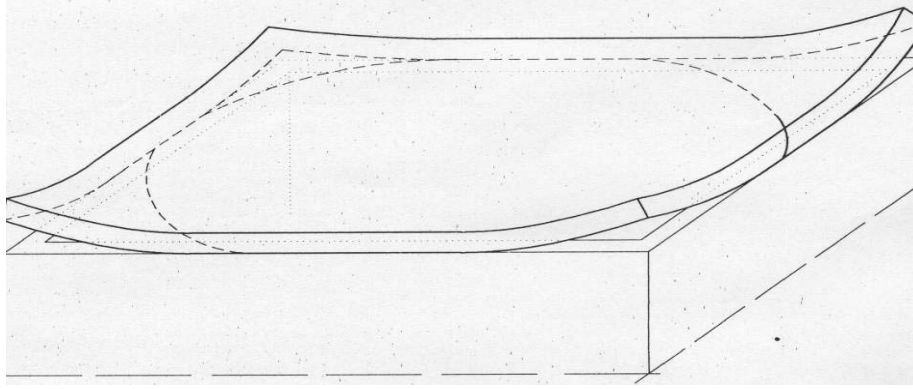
Kirişsiz, betonarme döşemelerde zimbalama etkisi
